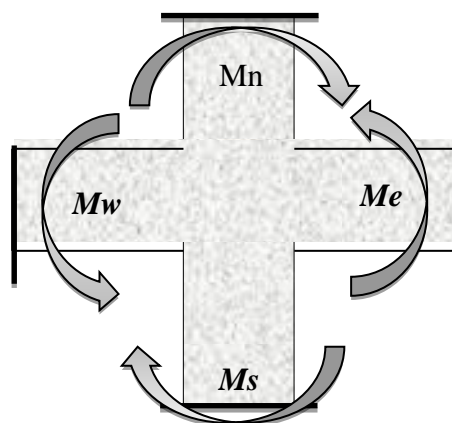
Dimensionnement d'un nœud de poutre poteau.
